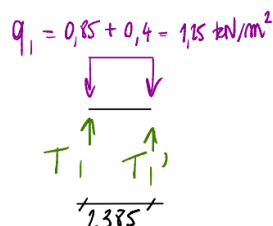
Schématisation de la poutrelle comme étant une poutre bi-appuyée
